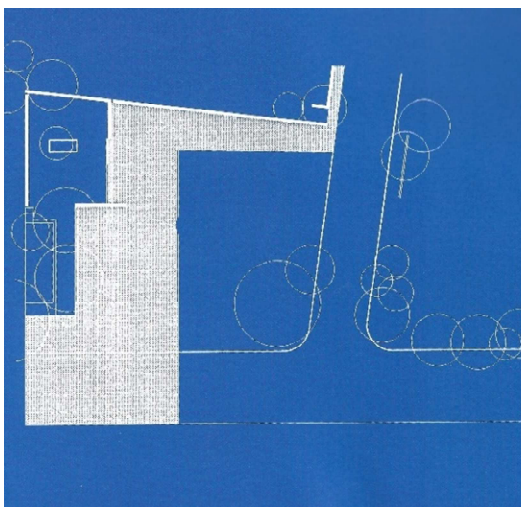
PLANTA DO ESPAÇO – IMAGEM: “BARRAGAN : OBRA COMPLETA”
